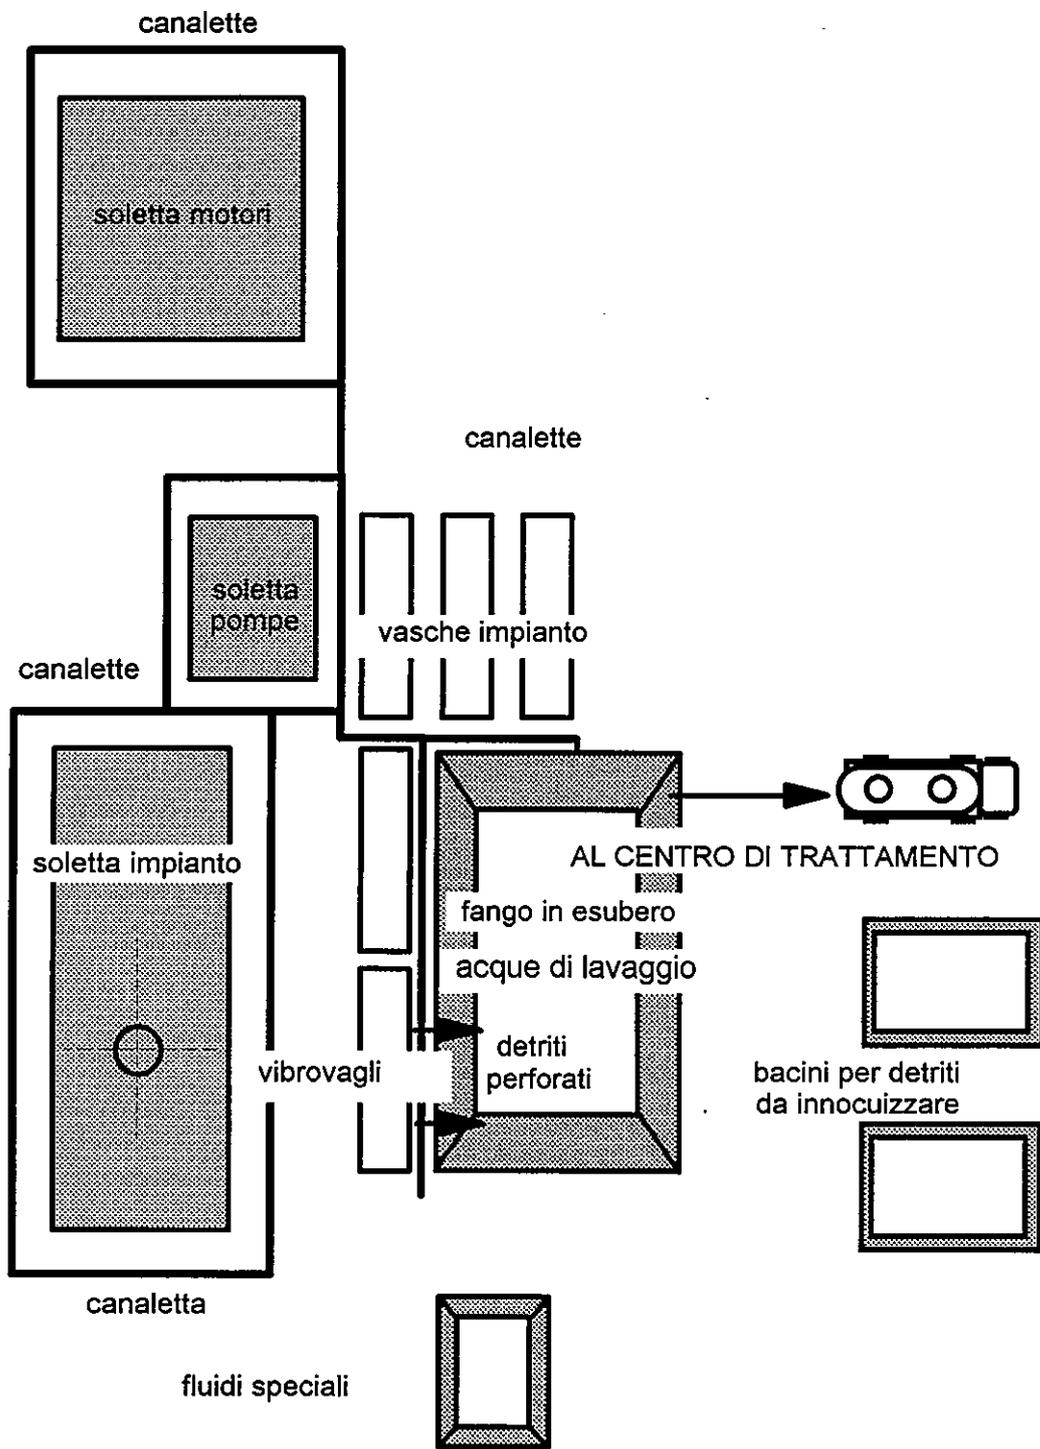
PLANIMETRIA POSTAZIONE DURANTE LA PERFORAZIONE
